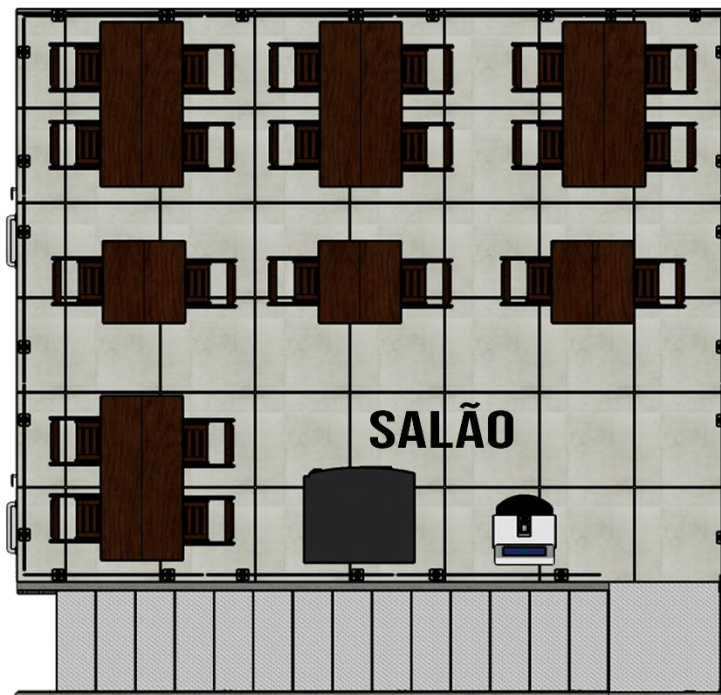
Planta Baixa Módulo Opcional Térreo Aberto
